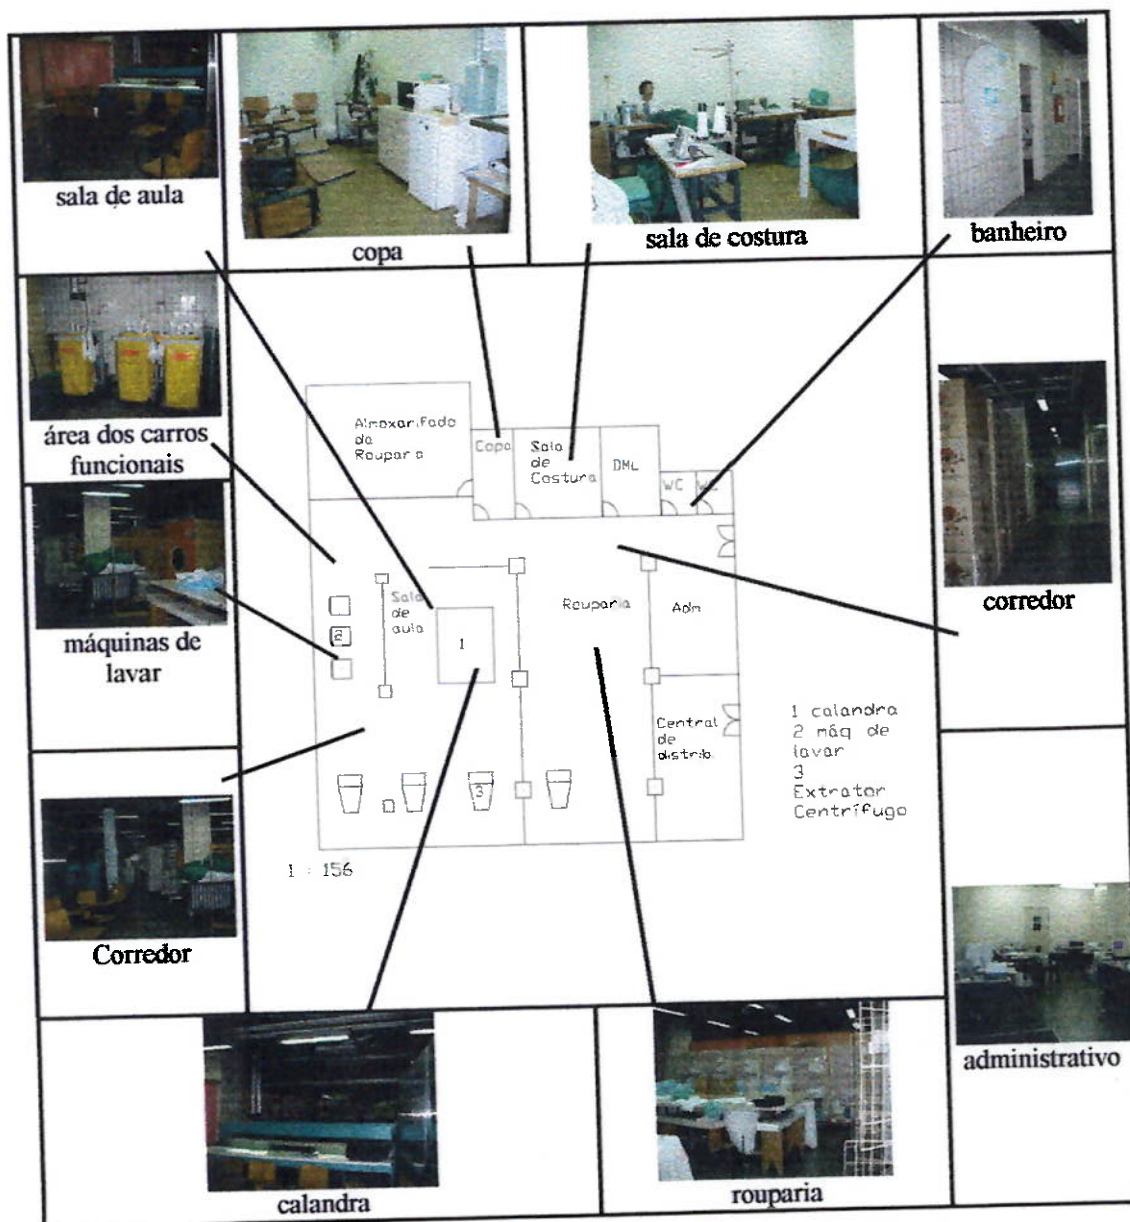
Planta do serviço de desinfecção hospitalar (elaborado pelo autor)
